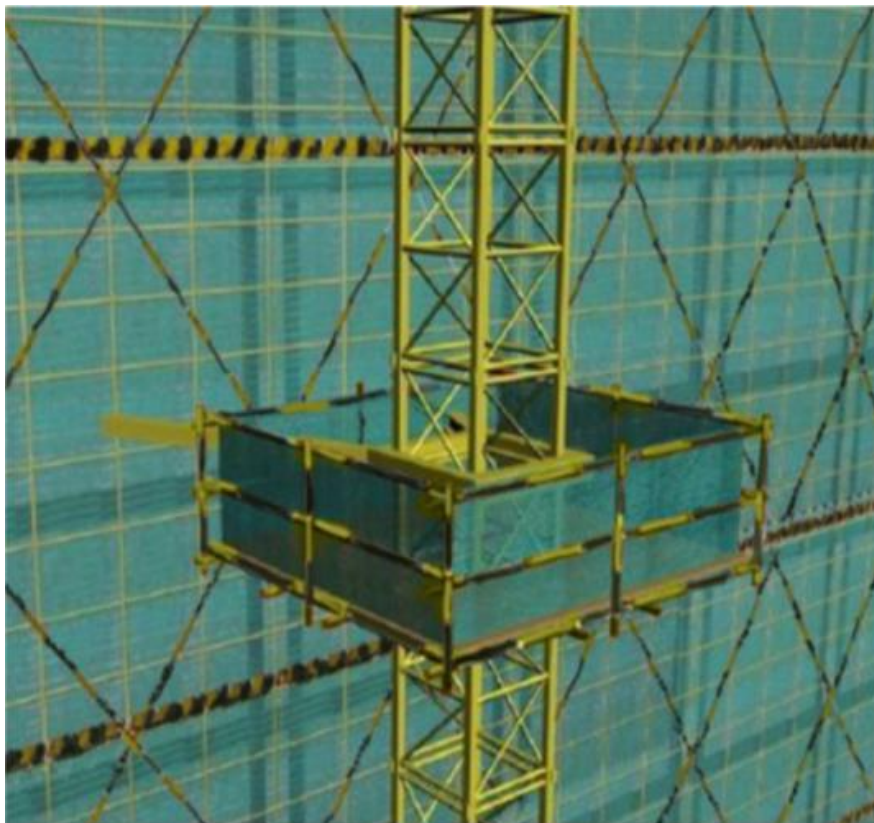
钢管脚手架式塔式起重机附墙安装上人通道、平台示意图
